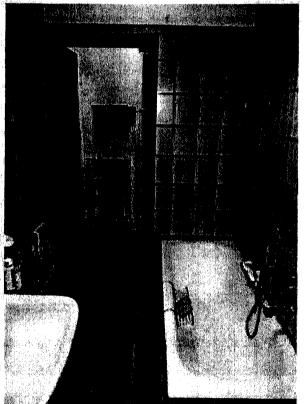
e 107 - Rilievo interno - Il locale bagno sul fronte Ovest del fabbricato.
